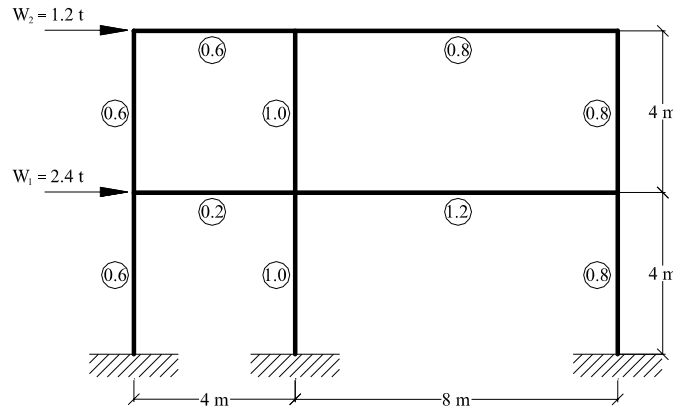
Pórtico sometido a fuerzas horizontales
